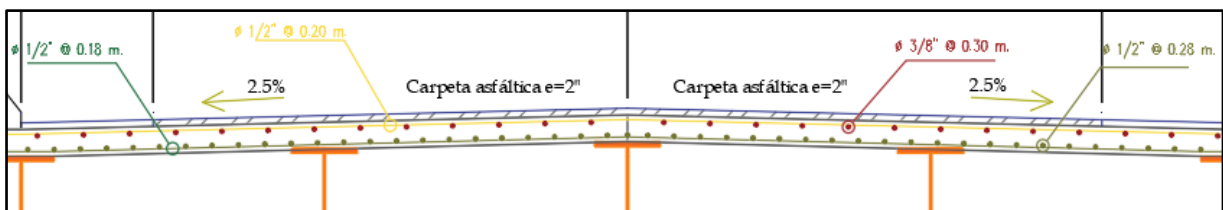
Distribución de acero en sección de losa apoyada en vigas metálicas.
